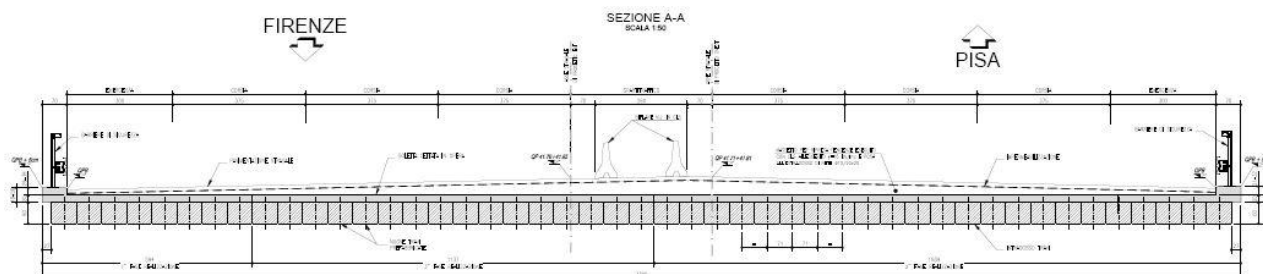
Sezione tipo ampliamento sottovia
